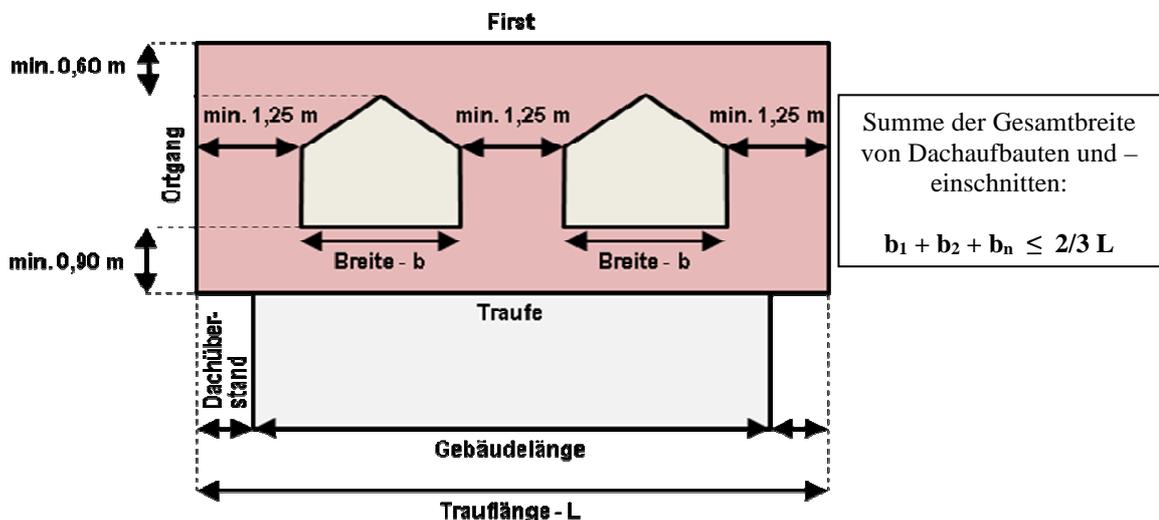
Abmessungen zulässiger Dachgauben (hier Beispiel: Sattelgaube)
